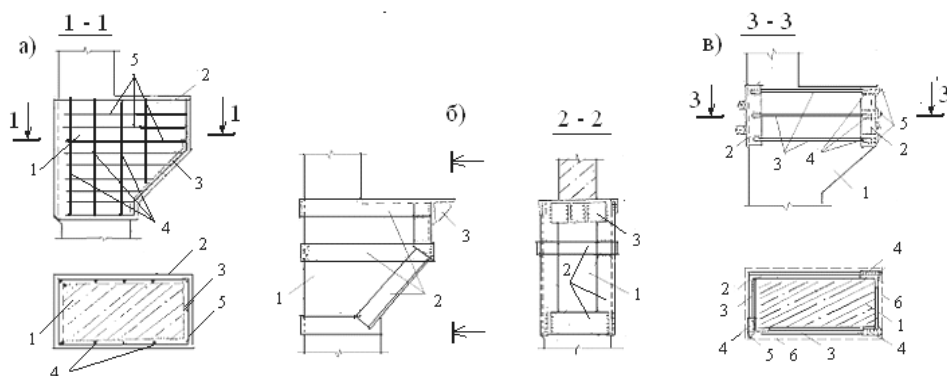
Усиление консолей железобетонных колонн устройством железобетонной (а) и металлическими (б,в) облоймами:
